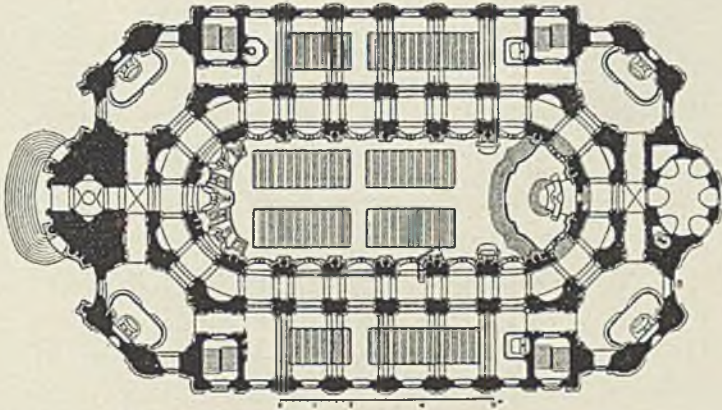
Grundriß der katholischen Hofkirche zu Dresden
